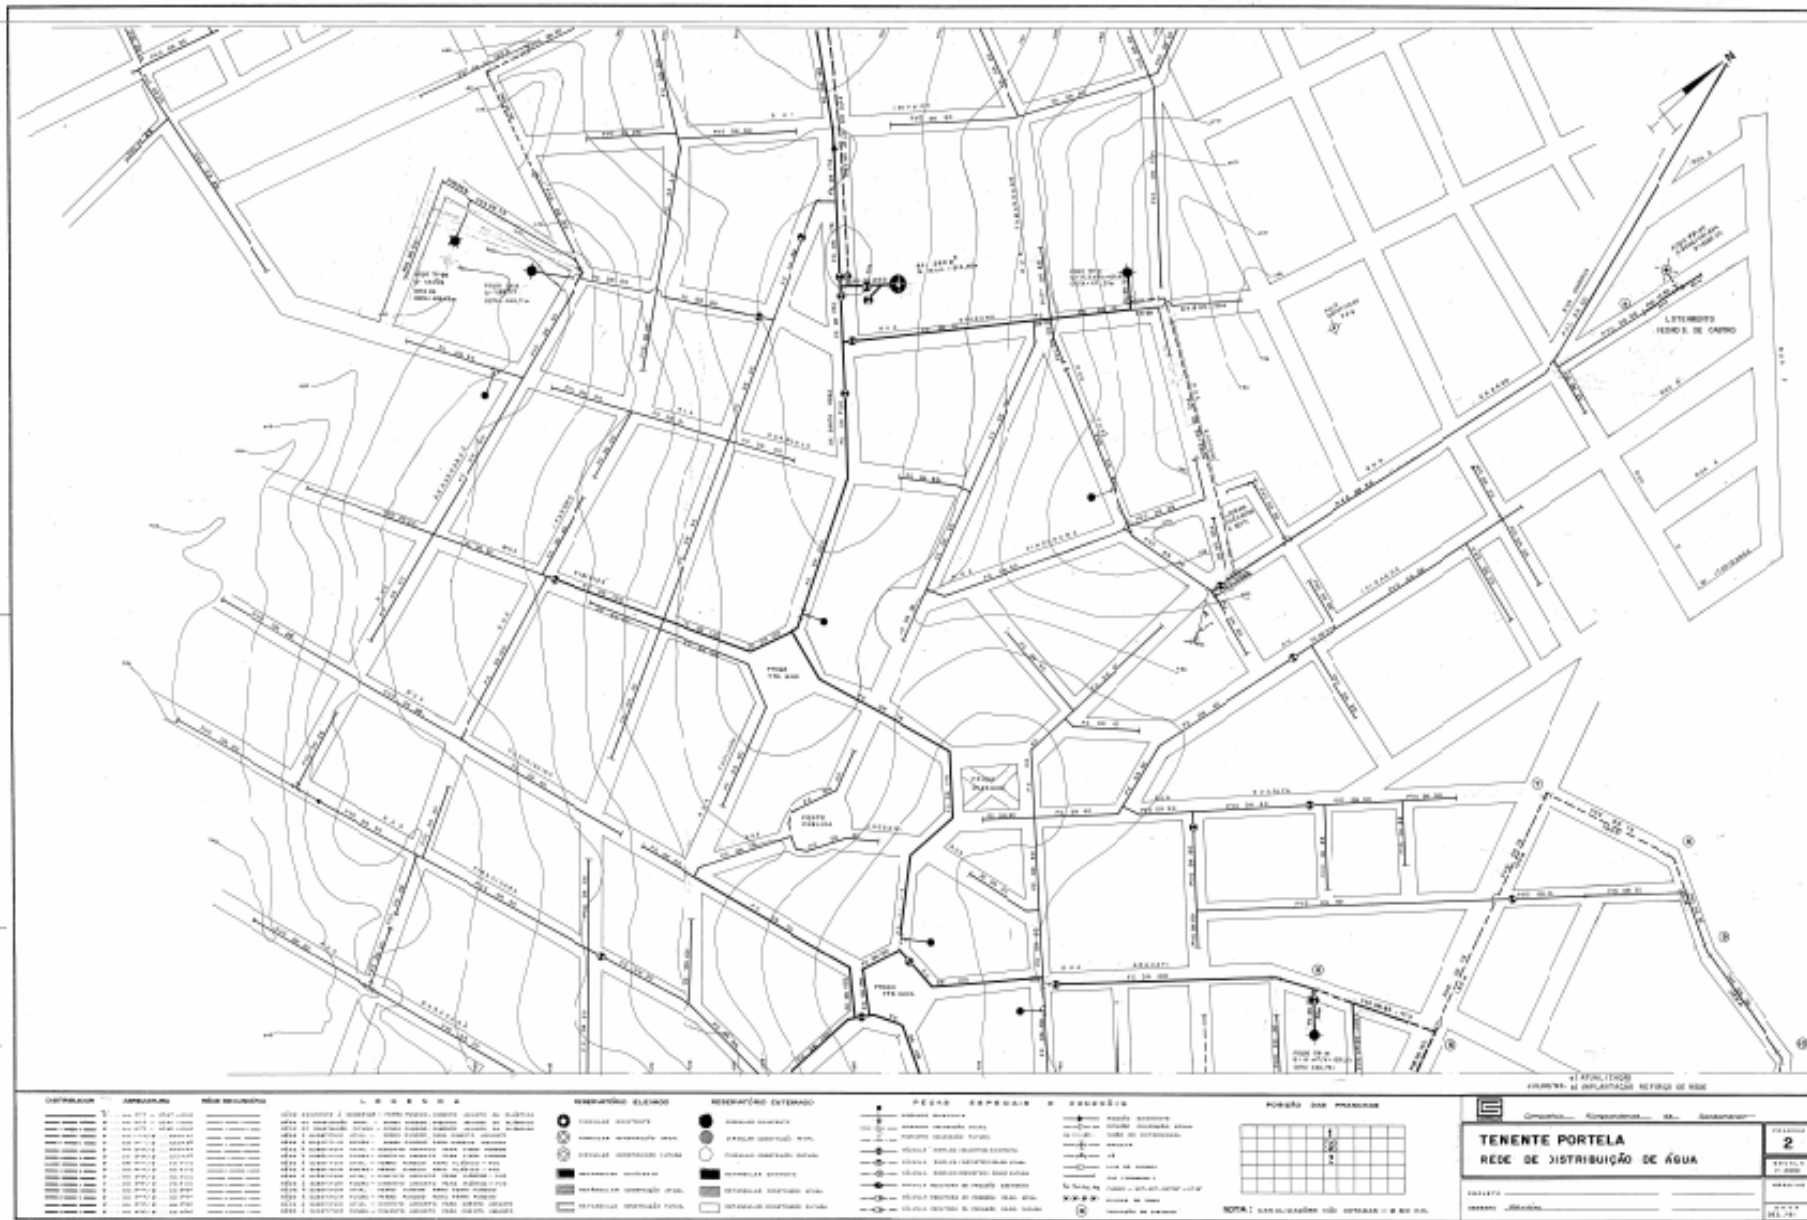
Planta da rede de abastecimento de água na área urbana (Prancha 1).
